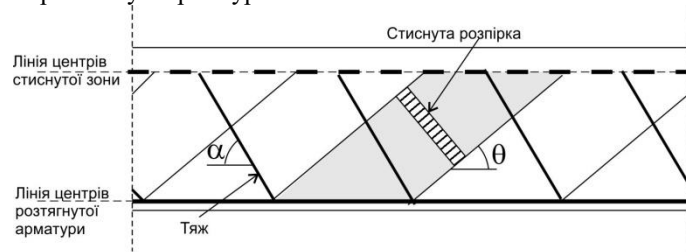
«Фермова» модель: α - кут нахилу поперечної арматури, θ - кут нахилу умовних бетонних розпірок
